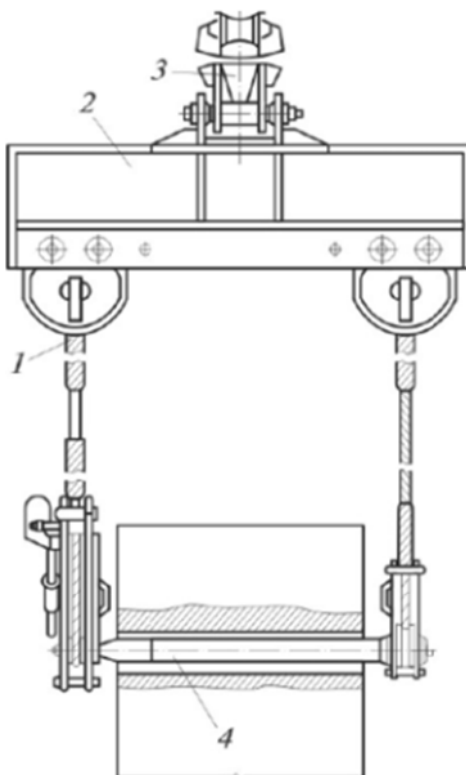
Строповочное устройство для монтажа колонн - унифицированная траверса: 1 — строп; 2 — балка; 3 — подвеска; 4 — палец;
